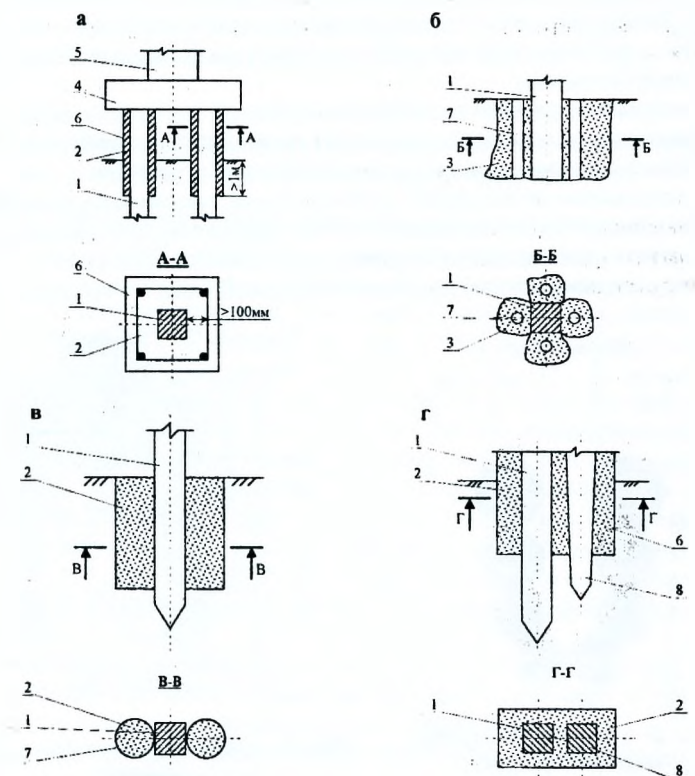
Усиление свай железобетонной обоймой (а), сплошной бетонной рубашкой (б), бетонированием скважины (в), коническими сваями (г):
